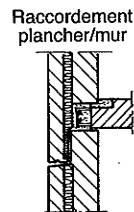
Coupe verticale partielle (cas d'un bâtiment de faible hauteur).
